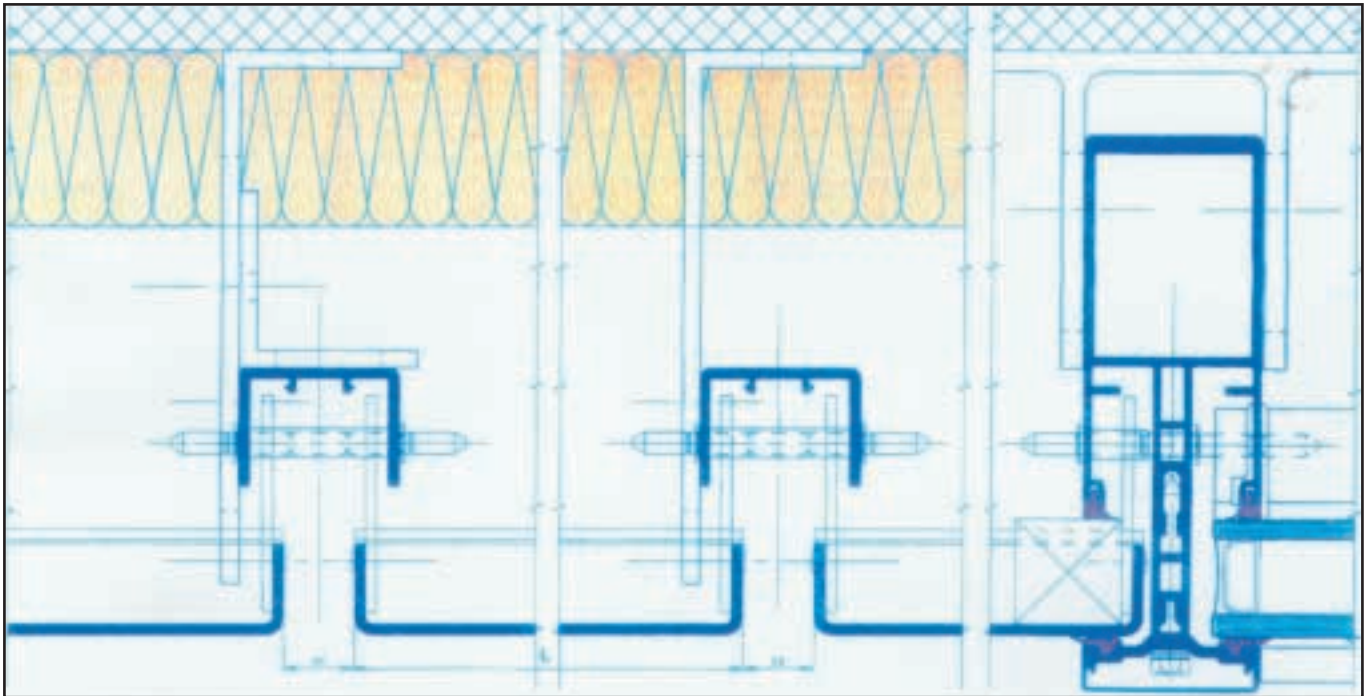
b) - Sezione orizzontale del sistema di rivestimento Alcoa Teknowall: versione normale
